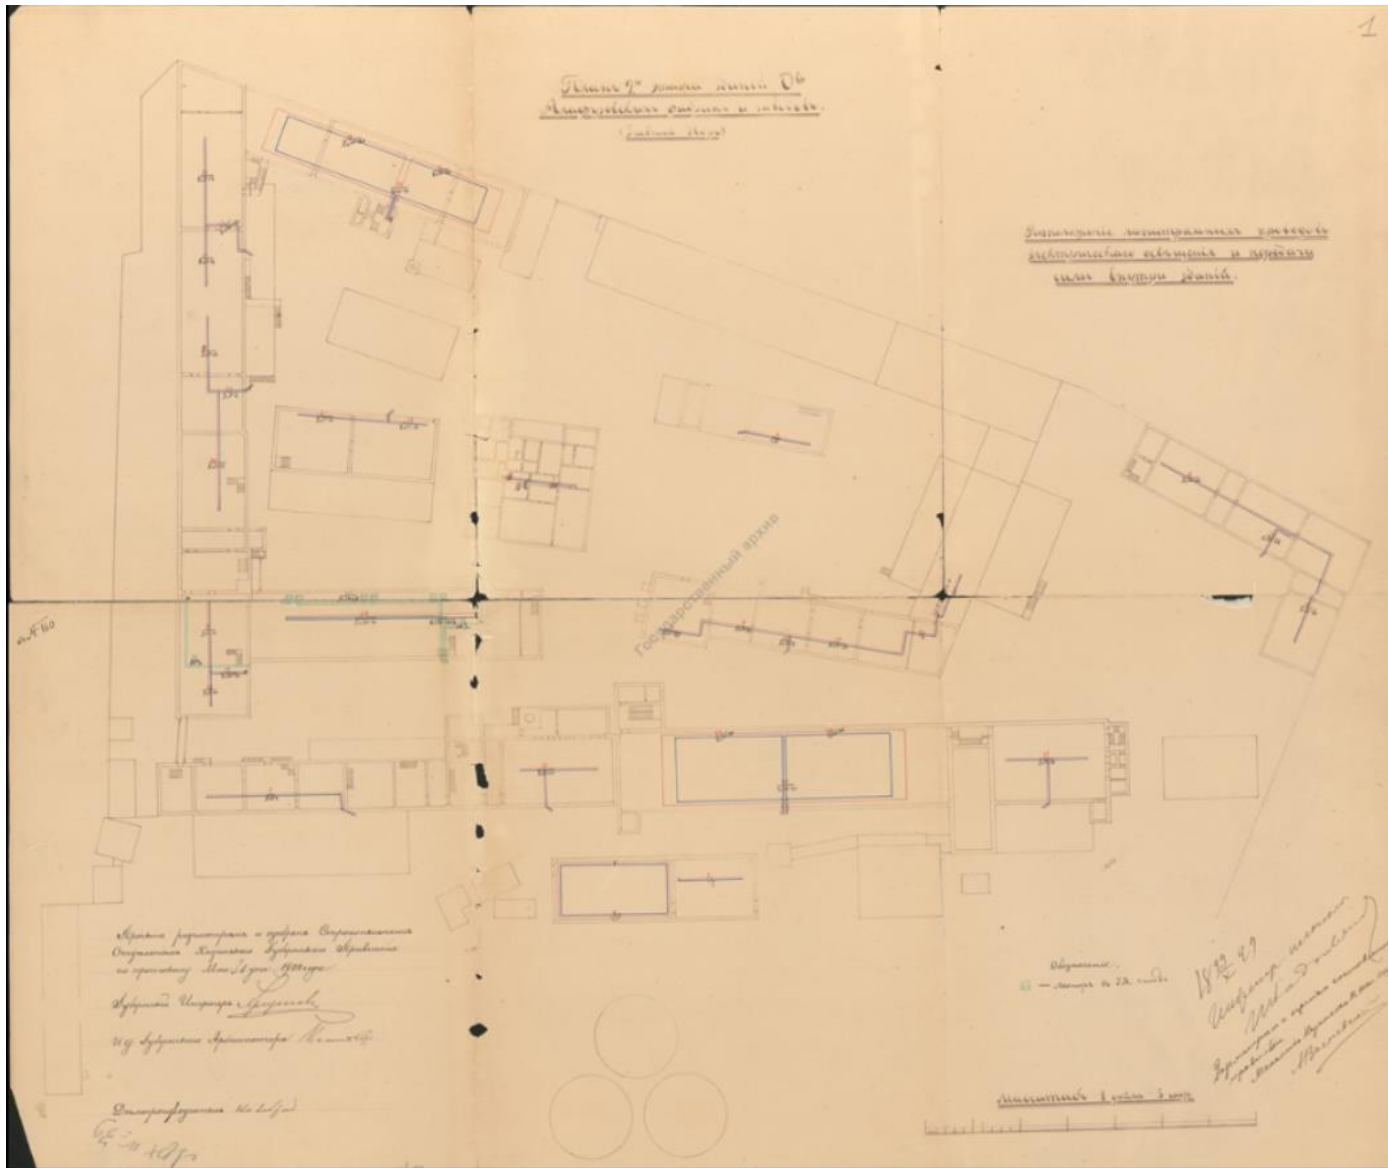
План 2-го этажа здания общества Алафузовских фабрик и заводов ф.2, оп.15, д.603
